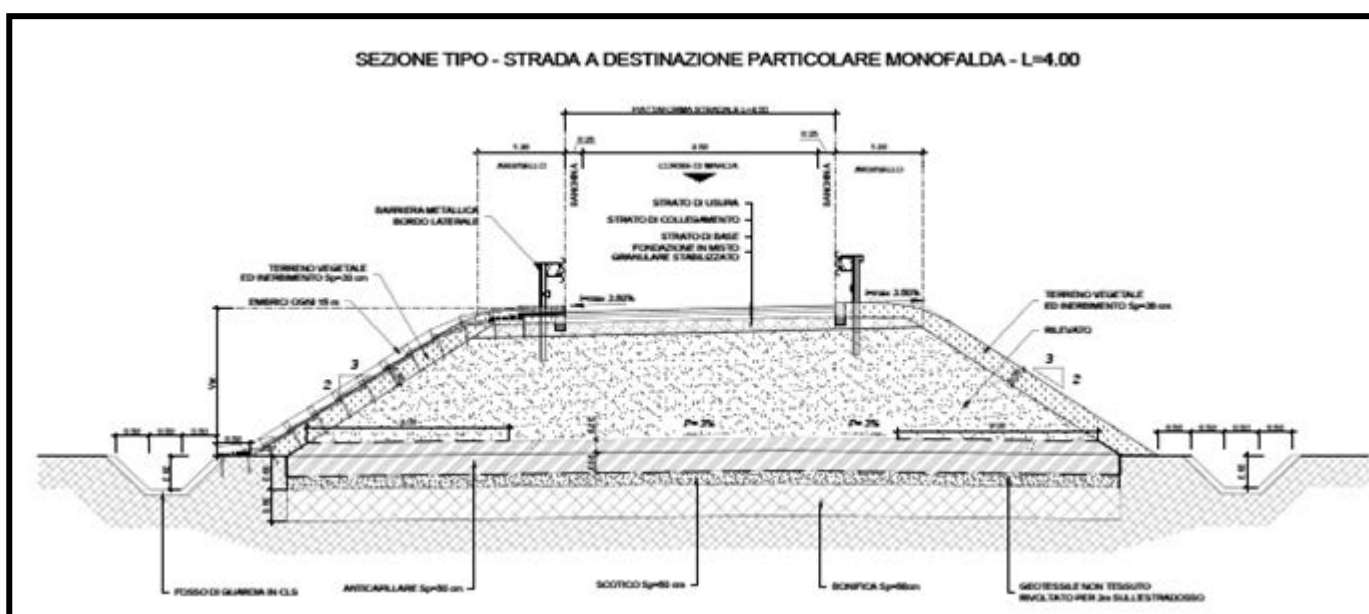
Sezione tipo di Progetto a destinazione particolare
